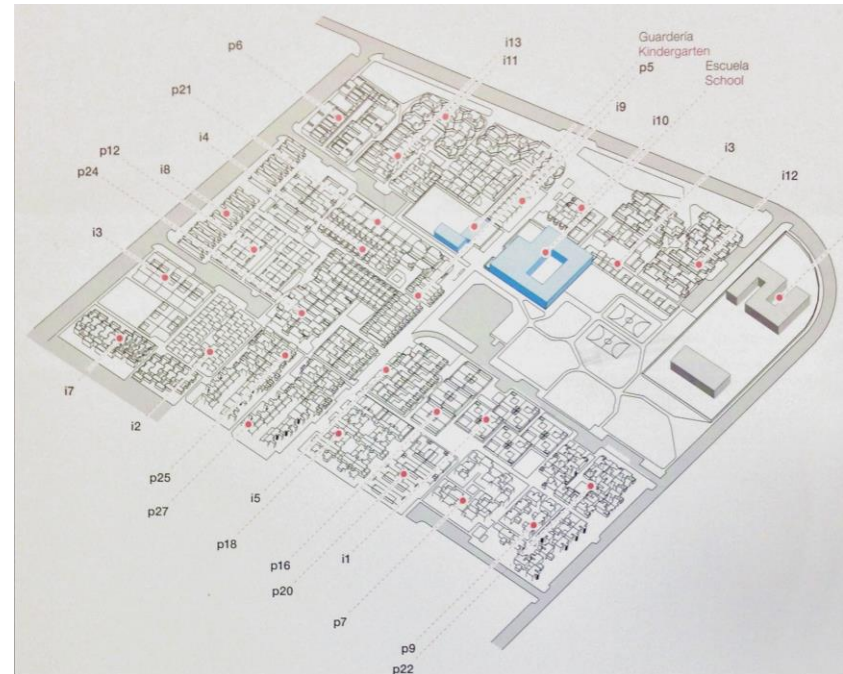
Plan Maestro 1978: Vivienda (negro), Educativo (azul).
